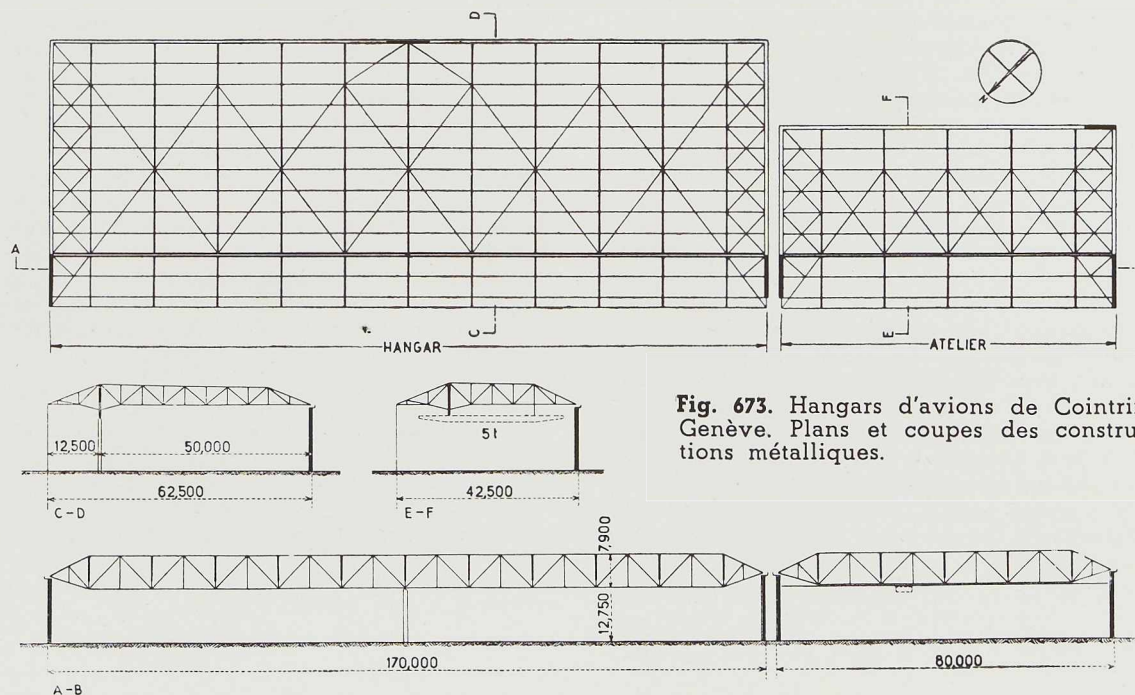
Hangars d'avions de Cointrin-Genève. Plans et coupes des constructions métalliques.
